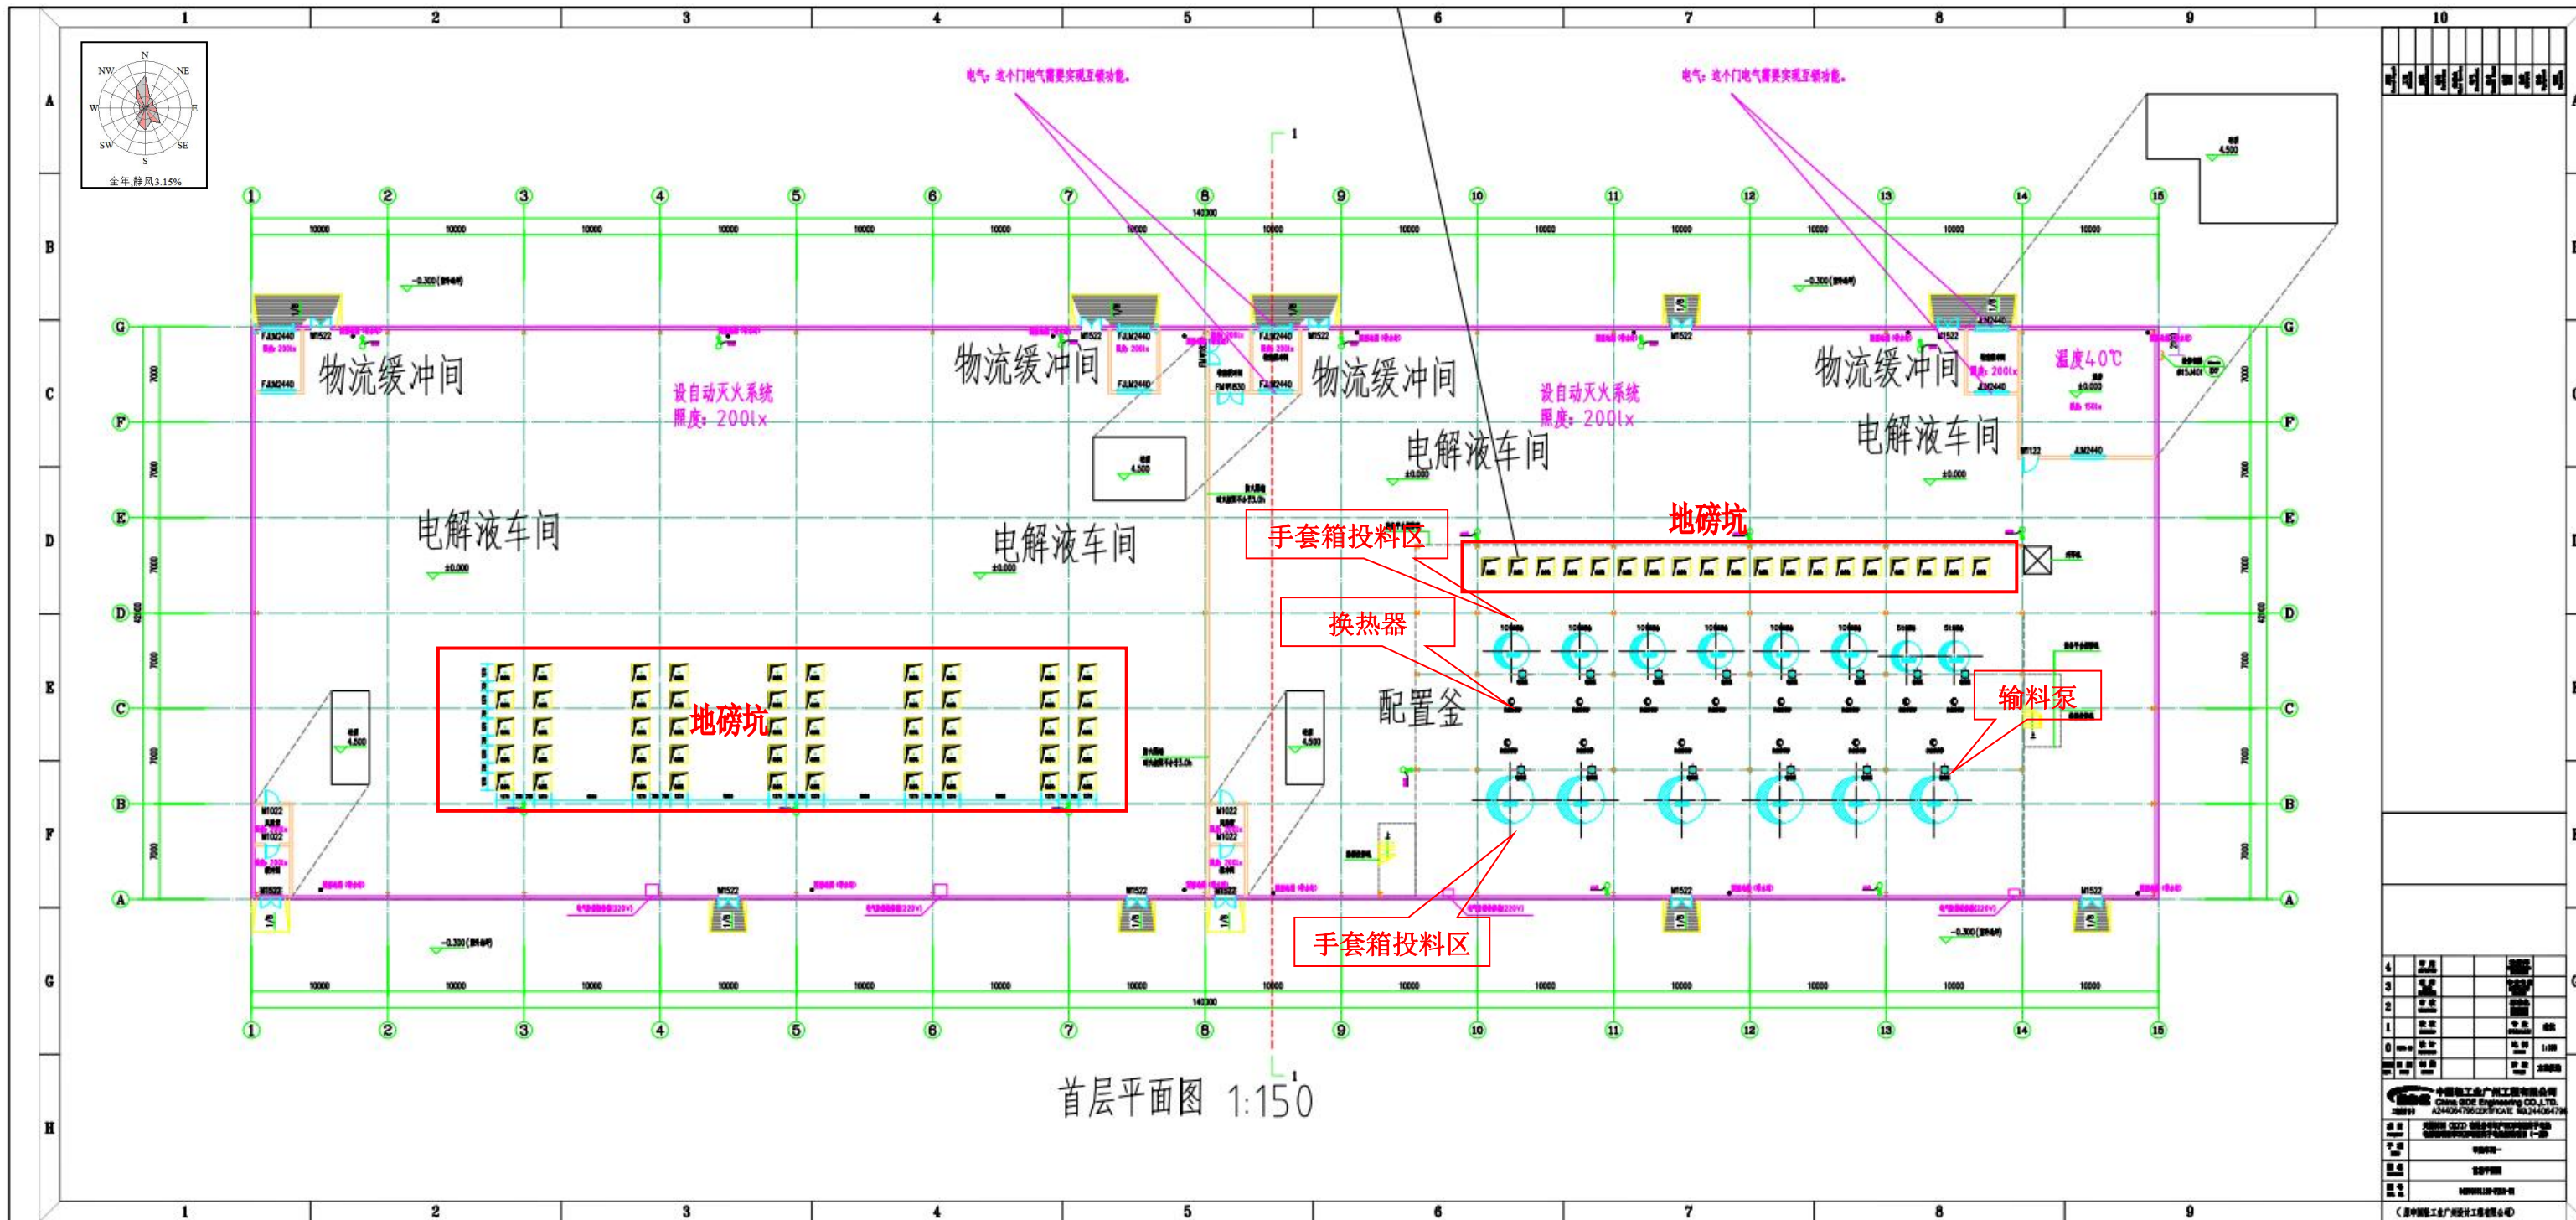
电解液车间（甲类车间一）平面布置图（比例尺1:150）
